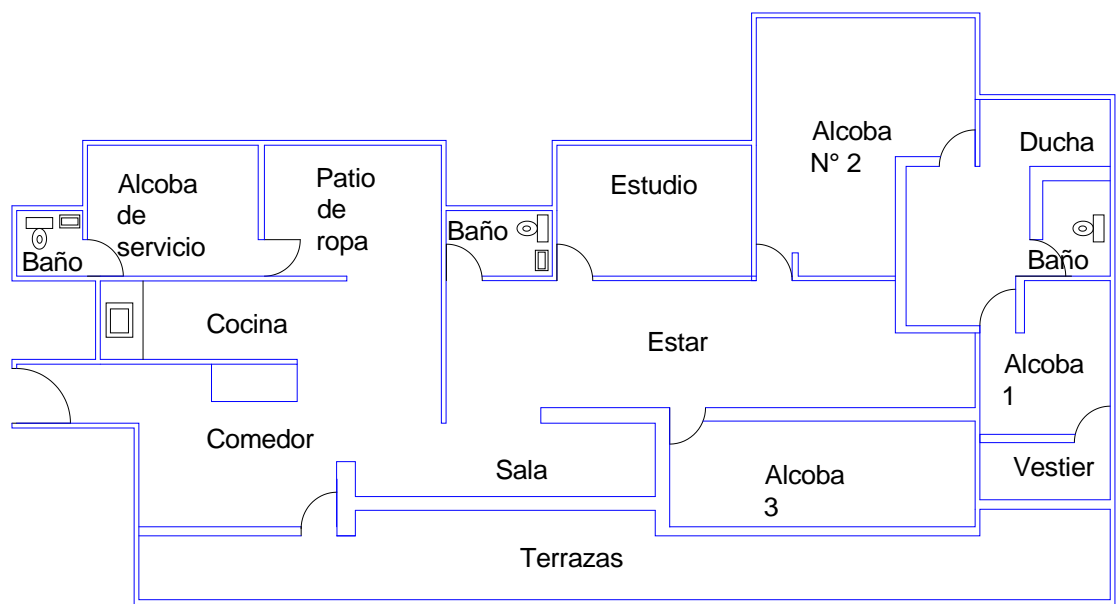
Planta tipo del apto. con la ubicación de los aparatos sanitarios
